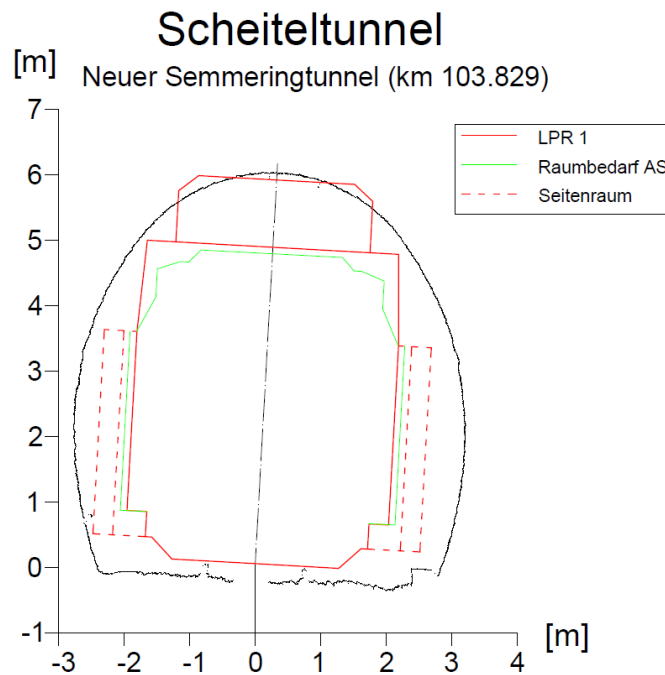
Tunnelprofil Scheiteltunnel (Neuer Semmeringtunnel) [87]
